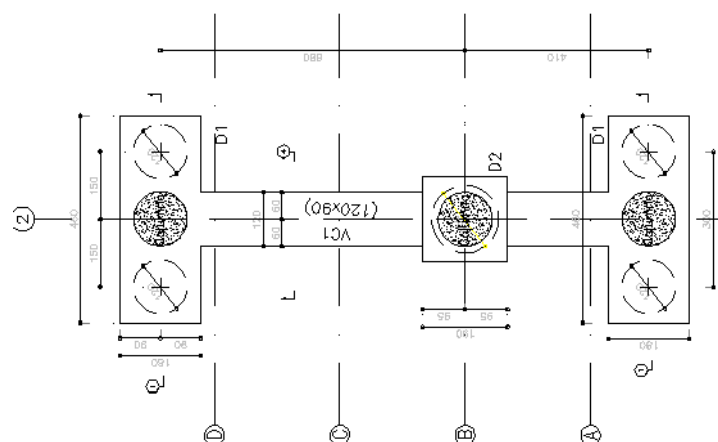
Planta dado D1, D2 y VC1 eje 2.
